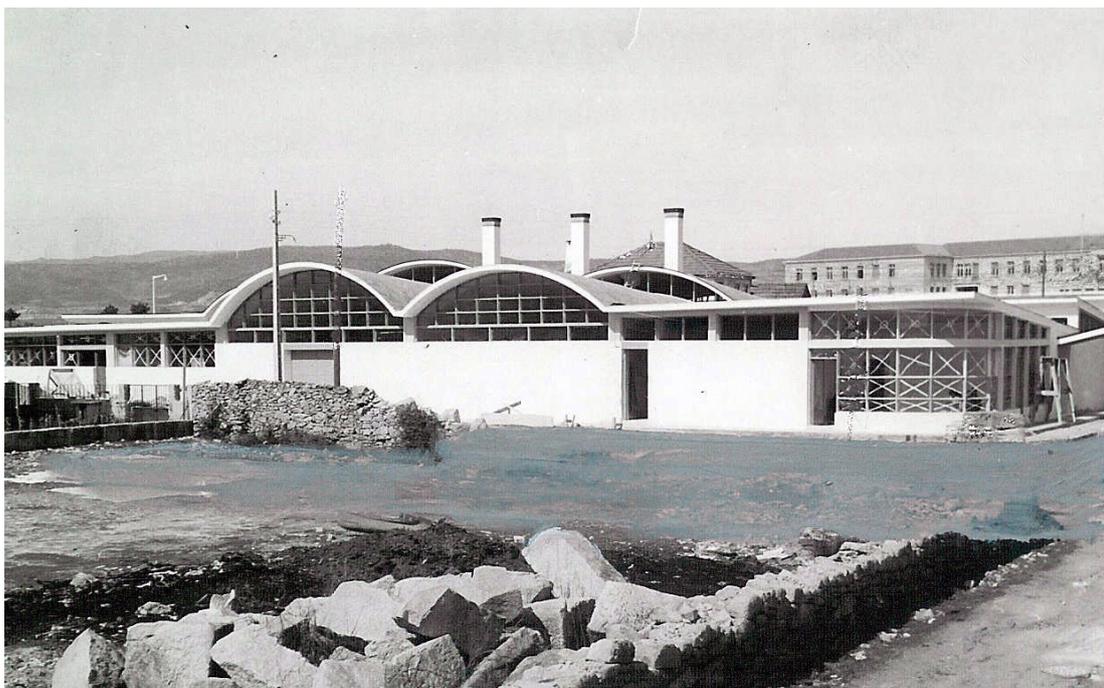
Nadir Afonso, Panificadora de Chaves em construção, 1962-64.
